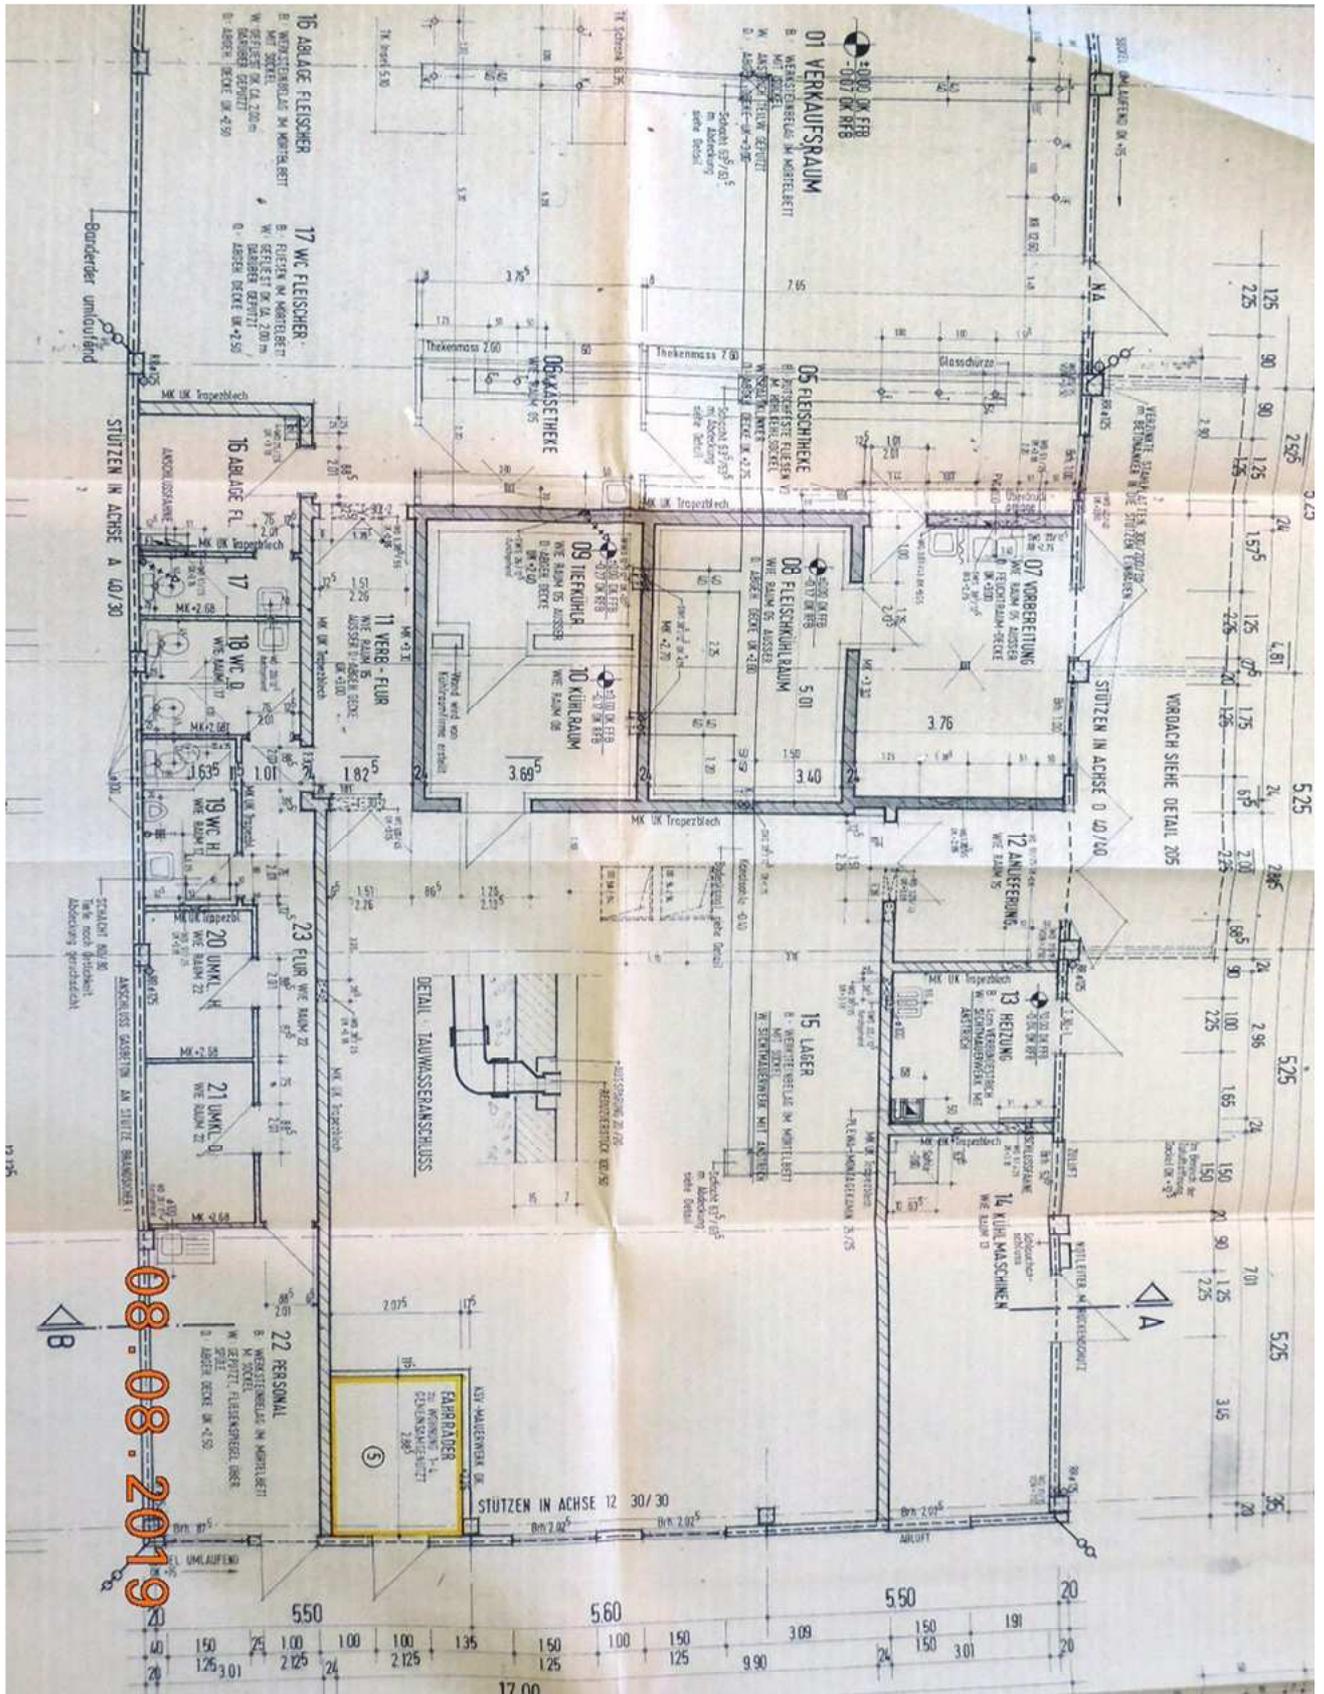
Grundrissplan Erdgeschoss rückseitiger Bereich (nicht maßstabsgetreu, aus Bauakte)
